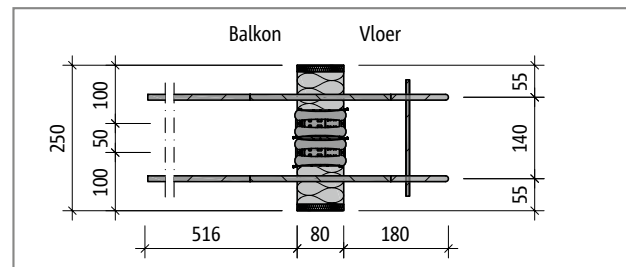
Schöck Isokorb® T type Q-E-V5-L500: Bovenaanzicht
